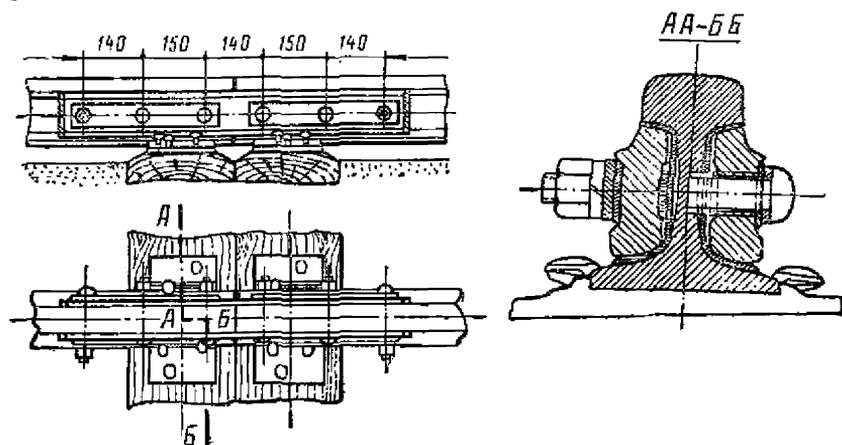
Изолирующий стык рельсов типа Р50 с двухголовыми металлическими накладками
